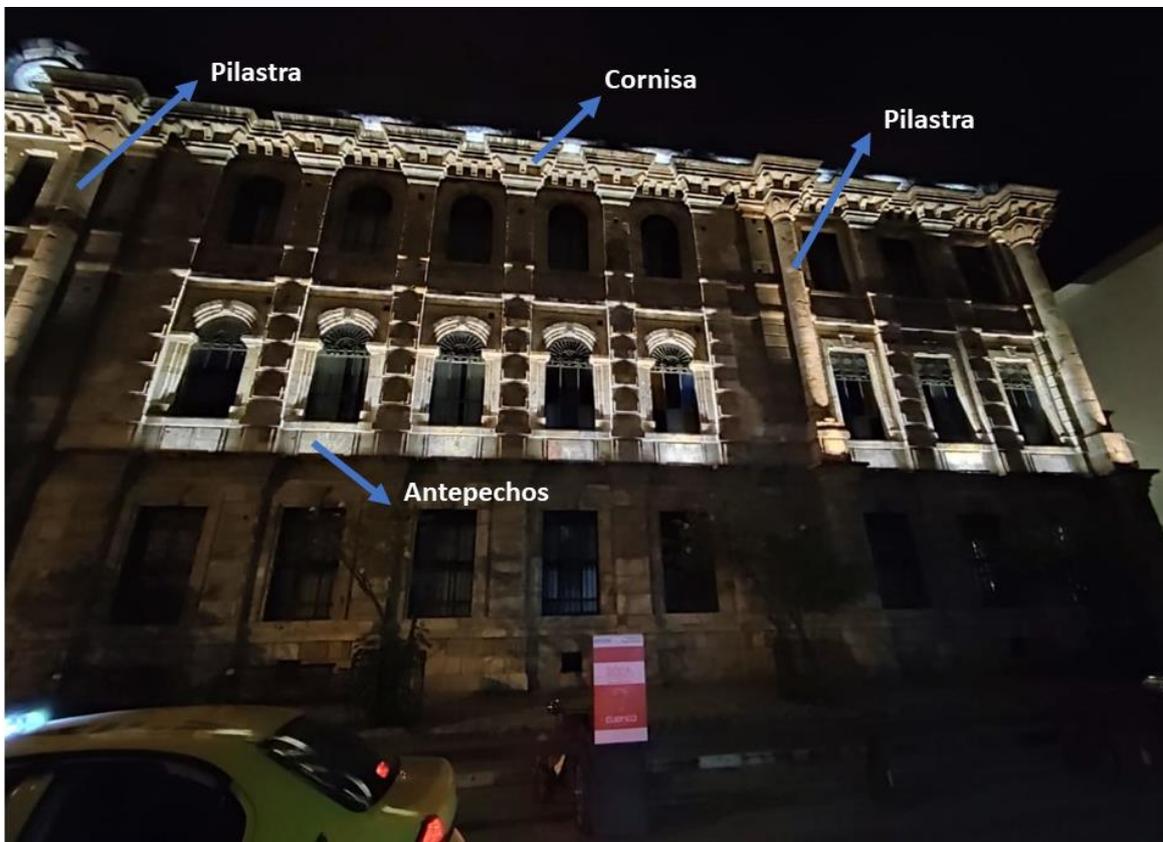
Secciones de la fachada lateral Luis Cordero Corte Provincial de Justicia. [Autores]
